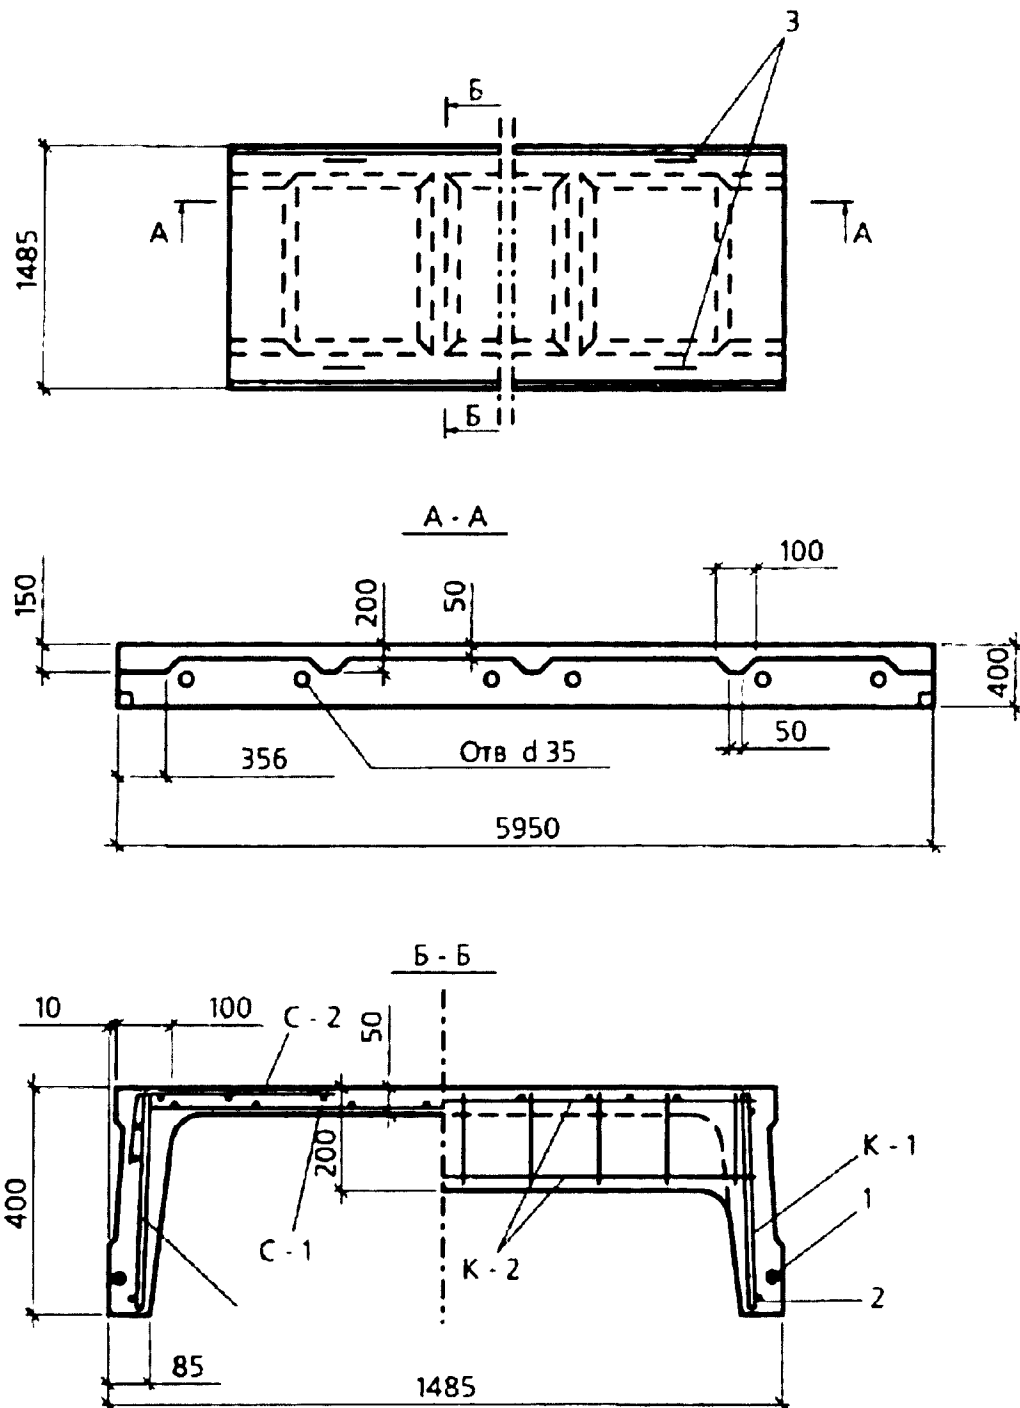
Армирование ребристой плиты перекрытия: 1 - напрягаемая арматура; 2 - ненапрягаемая арматура; 3 - петли для подъема; 4 - поперечная арматура (хомуты)
